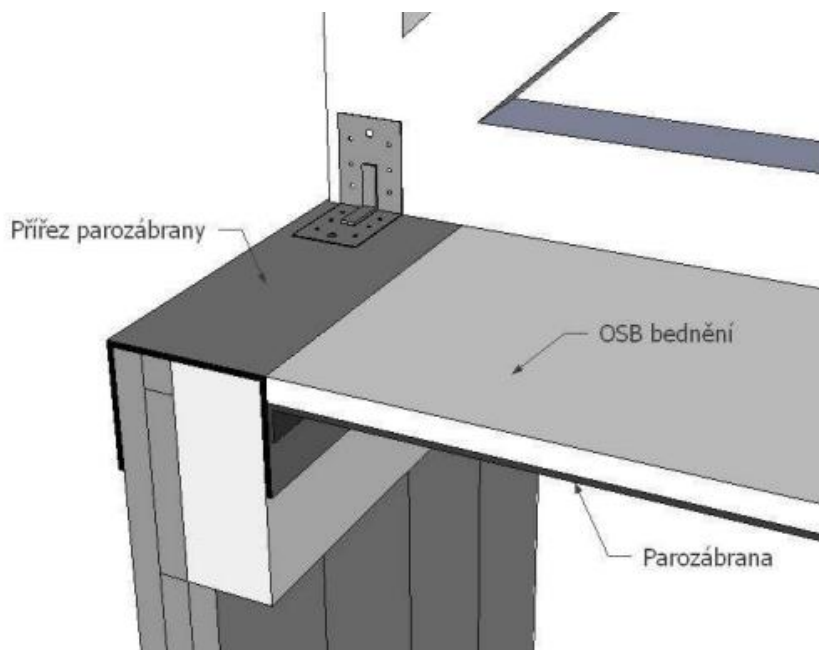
Uložení příhradových vazníků na Dekpanel s trémovou stropní konstrukcí [9]
